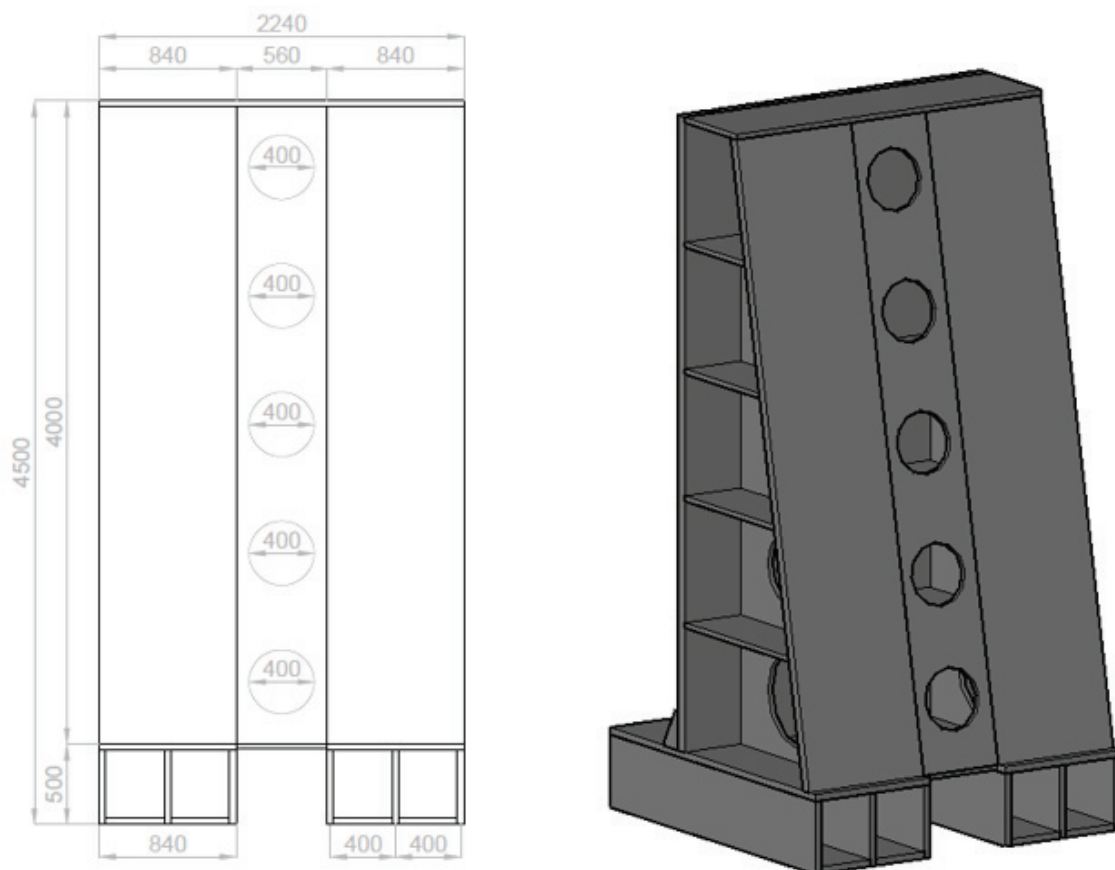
Prospetto posteriore e vista tridimensionale modello struttura n°4
